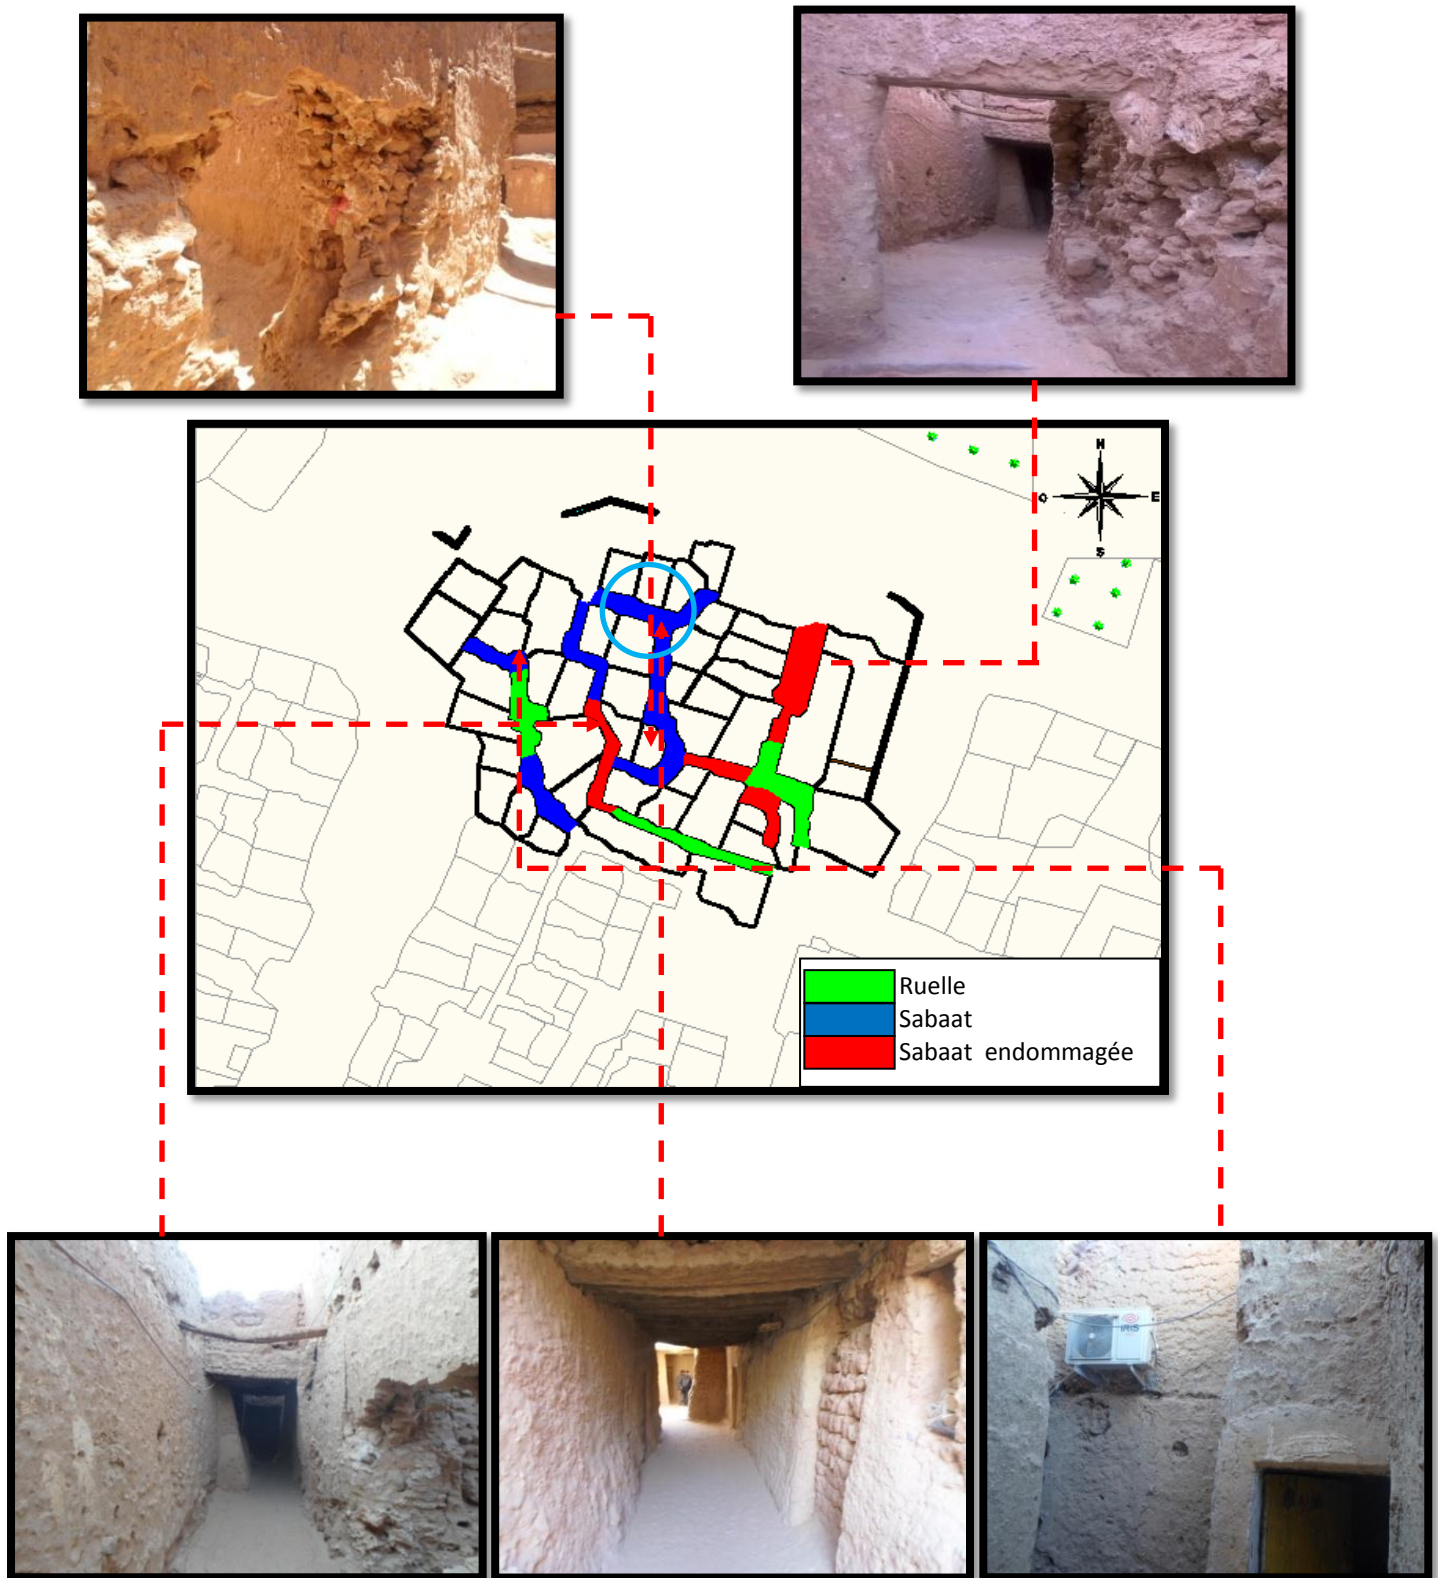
Plan de système viaire de la casbah de Taylout
